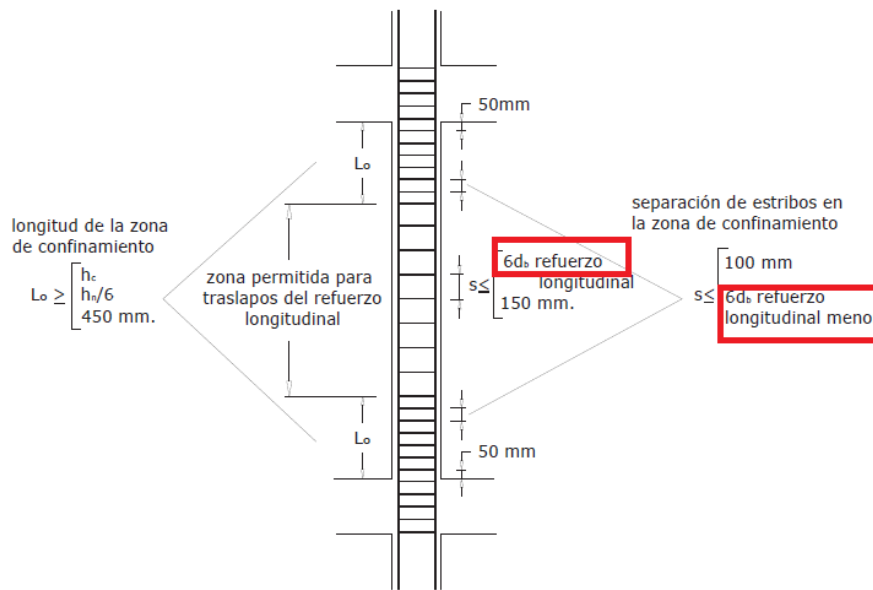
Separación de Estribos en Columnas. Fuente: Nicolás Pozo
